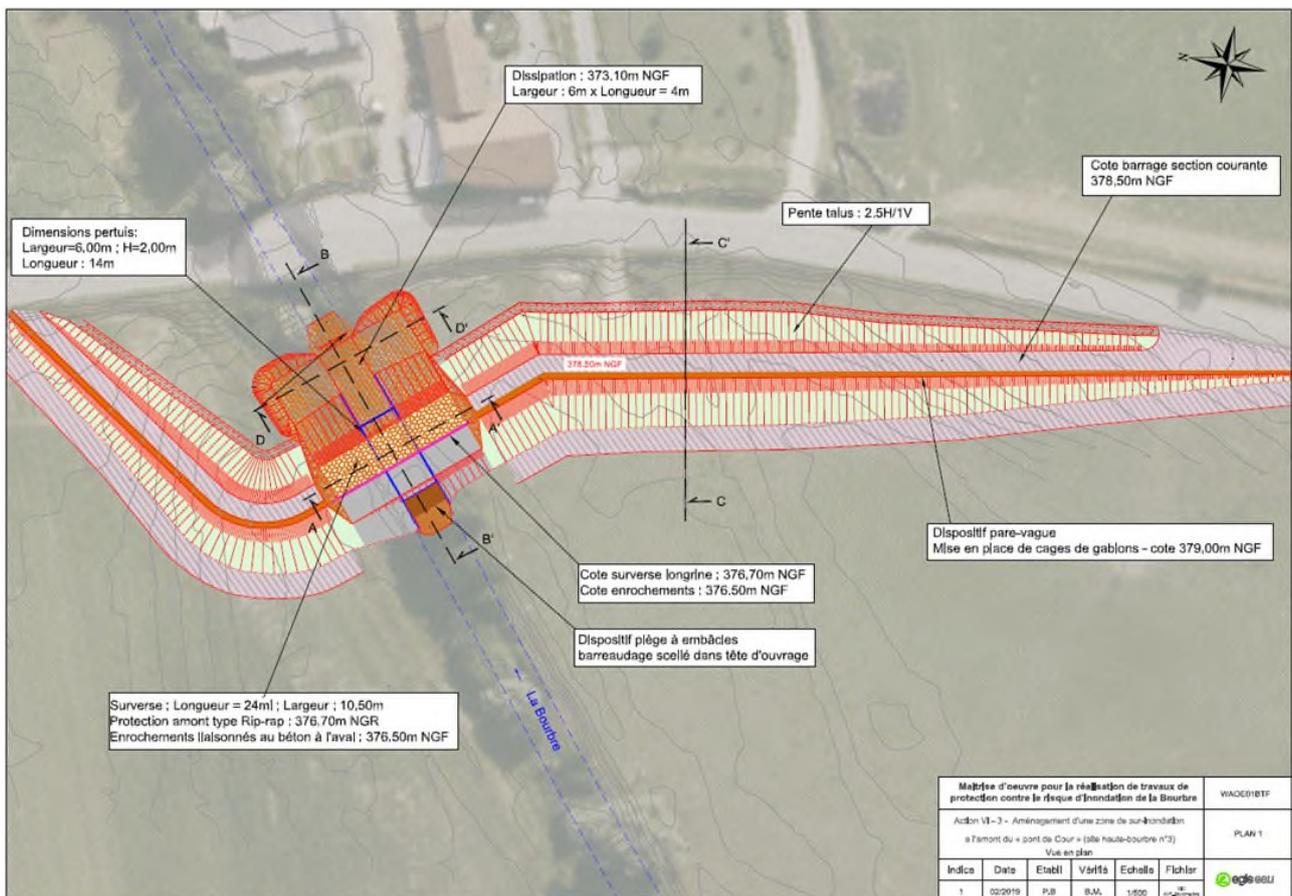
Exemple d'aménagement d'une zone de sur-inondation (Amont Pont de Cour, site haute bourbre n°3, action Papi n°VI-3). Source : Dossier.
